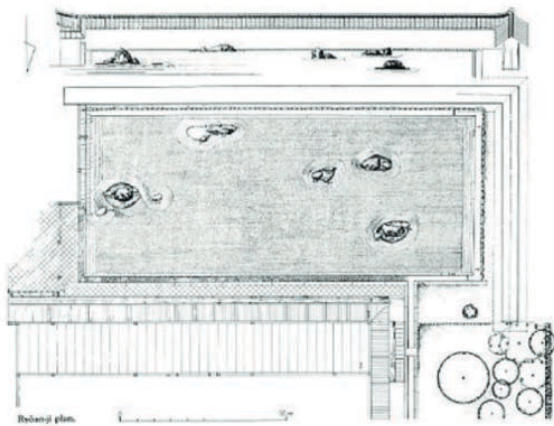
Planta del jardí sec del temple Ryōan-ji, Kyoto.
